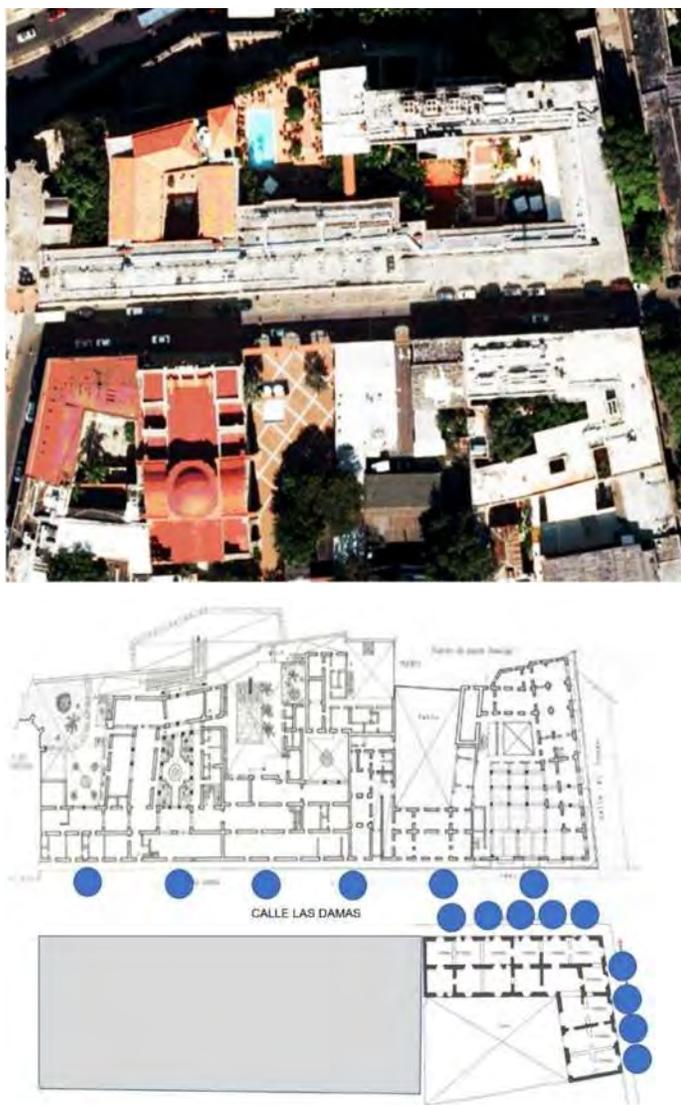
11. Se marcan con círculo azul las quince casas mandadas a construir por Nicolás de Ovando. Arriba foto aérea; abajo primera planta del conjunto marcando distribución de las casas Fuente: foto de Google Earth; dibujo: elaboración propia con plantas de casas en archivos del Centro de Inventario de Bienes Culturales.
